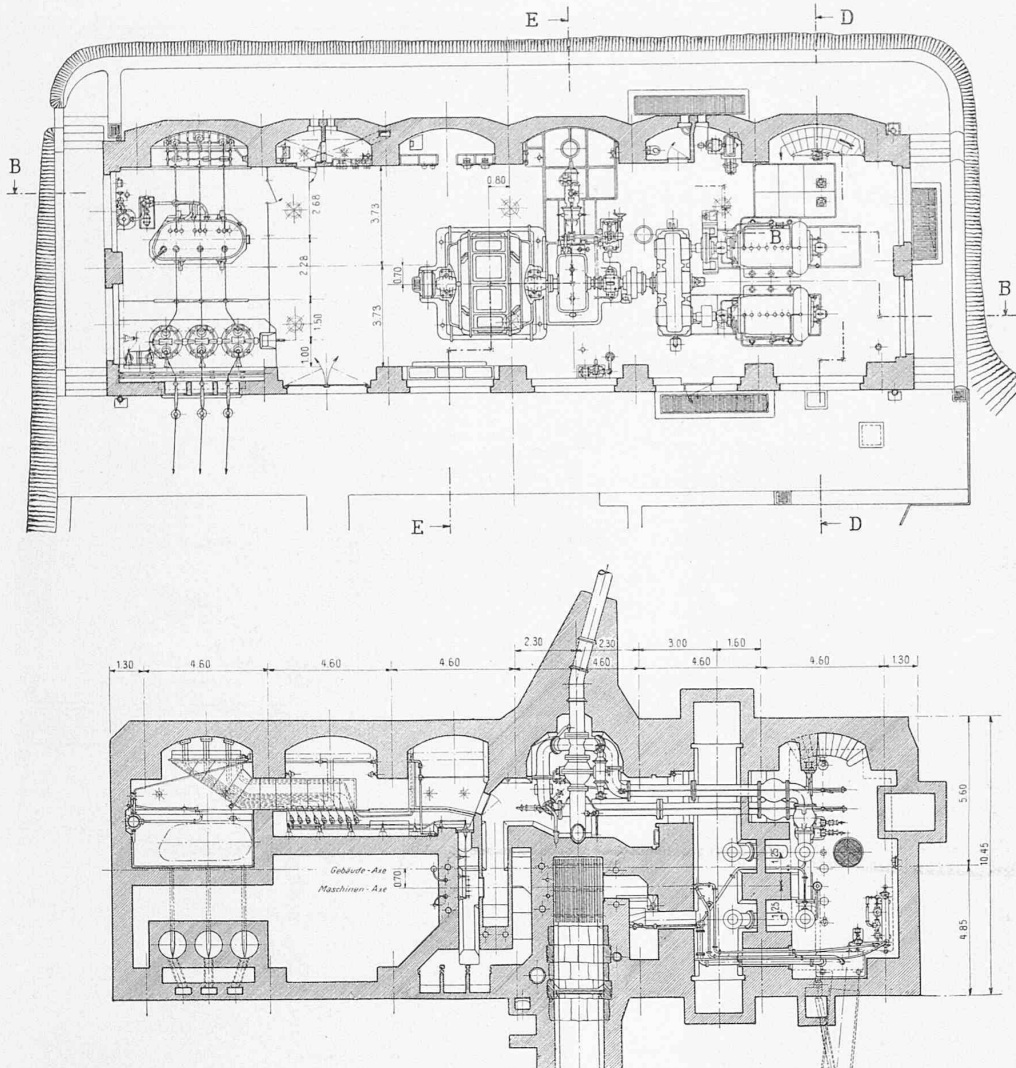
u. 17. Grundrisse des Untergeschosses und des Erdgeschosses des Maschinenhauses. — Masstab 1:250.
